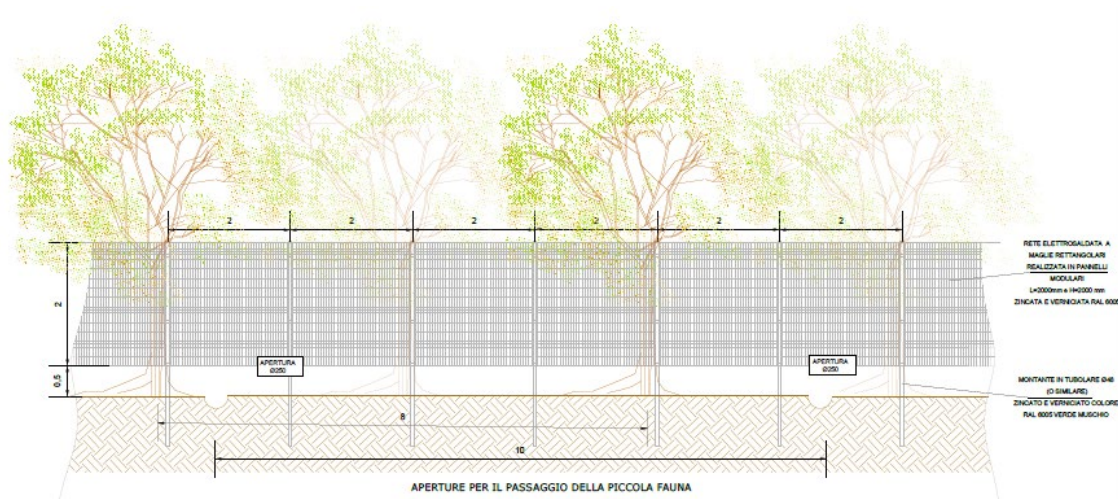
Prospetto recinzione perimetrale con mitigazione
